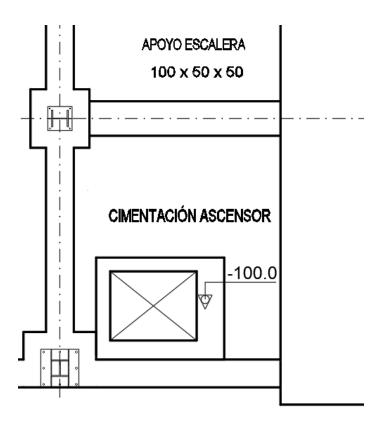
Zapata ascensor y escaleras. Fuente; Elaboración propia.
